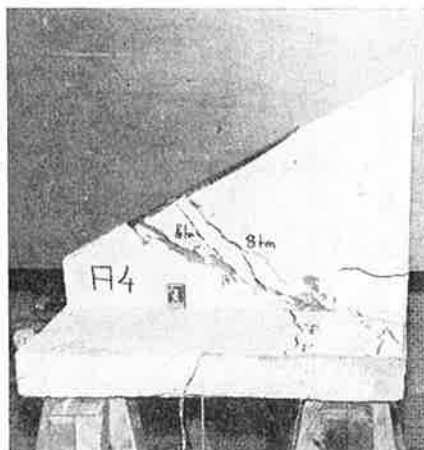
a. Brottfigur för element av typ K (utan gjutfog). • *Fracture pattern. Type K element (without construction joint).
